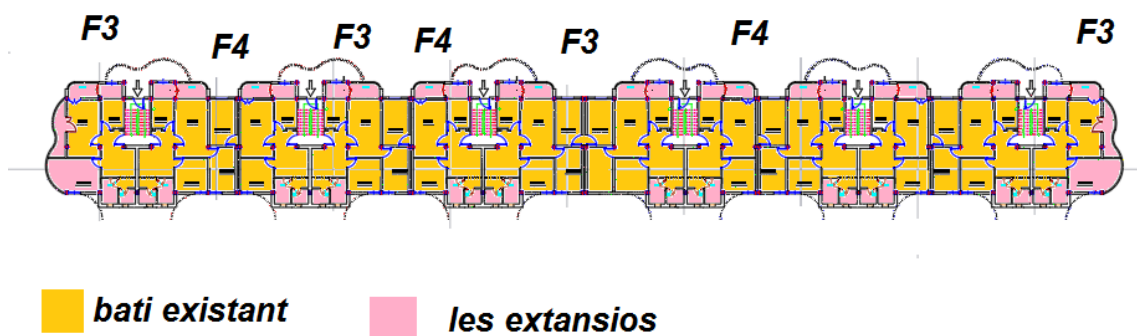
Plan intérieurs de bâti n° 5 , traité par l'auteur
